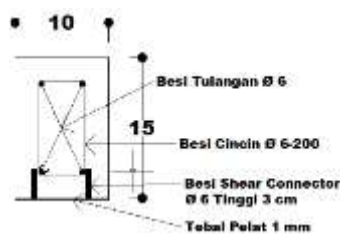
Benda Uji 3 Penampang Balok Beton Dengan Pelat Baja dan *Shear Connector* dengan jarak 7,5 cm.
